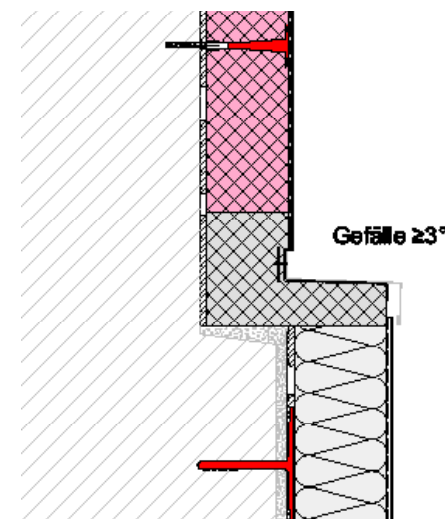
Ausführung mit Baumit SohlbankanschlussProfil
